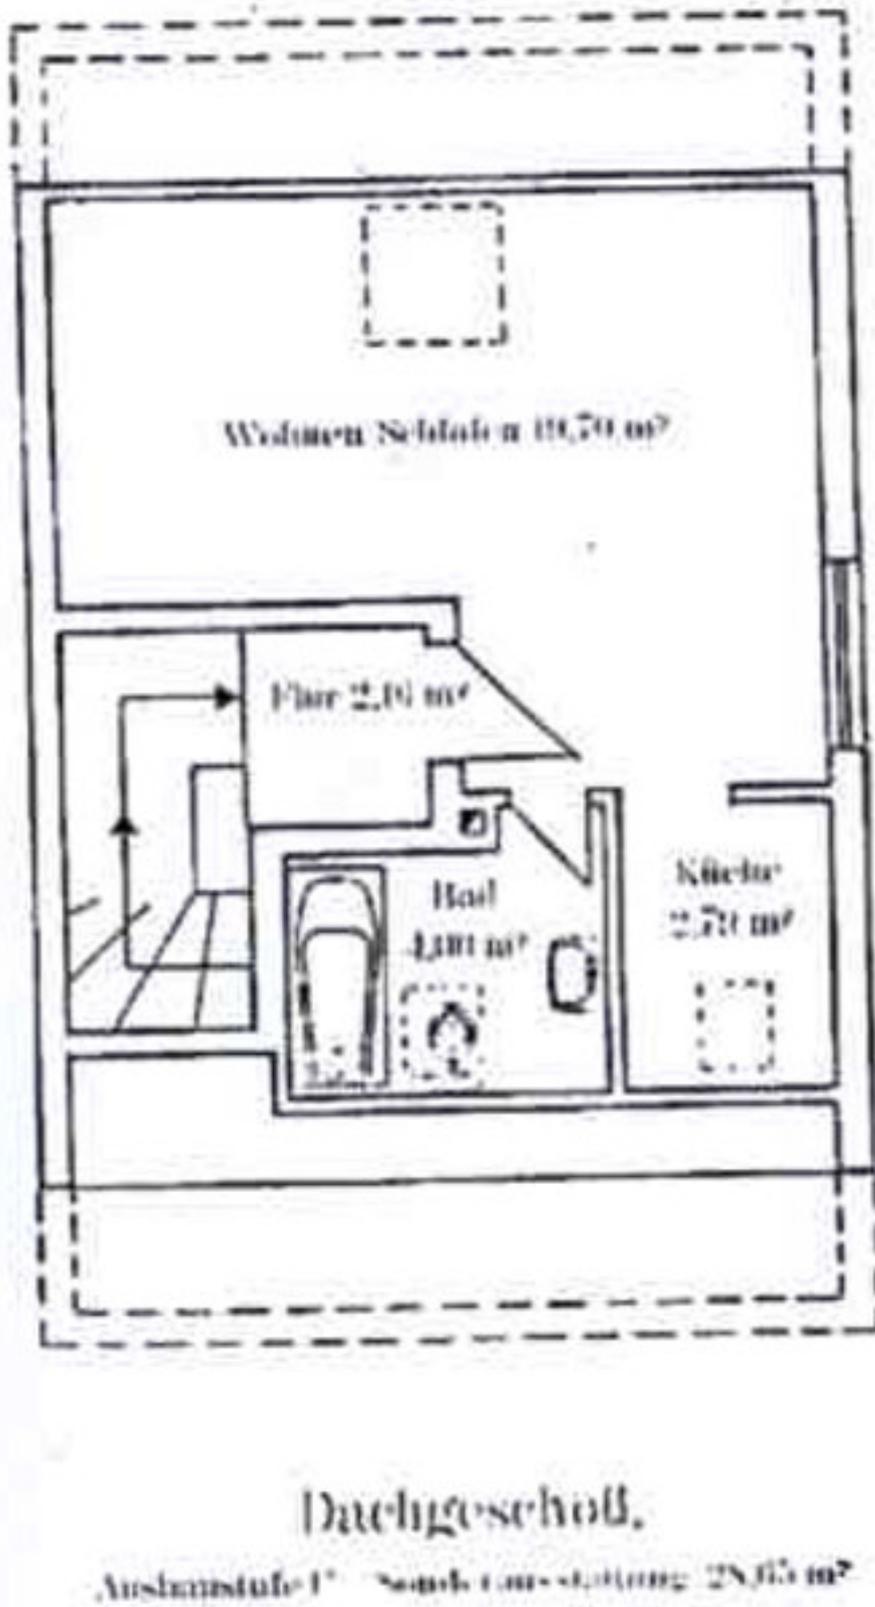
Grundrissplan Dachgeschoss; Quelle: Objektunterlagen von der Gläubigerin
